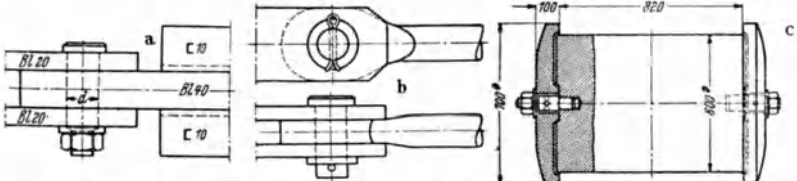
Gelenkbolzen. a) mit gewöhnlichen Schraubenbolzen, b) Bolzen mit Splint, c) großer Gelenkbolzen einer Hängebrücke (Rheinbrücke Köln-Deutz).
